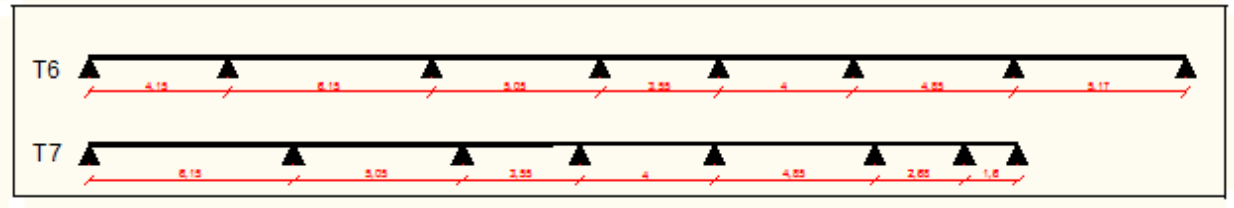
schémas statique des poutrelles de la terrasse accessible.
